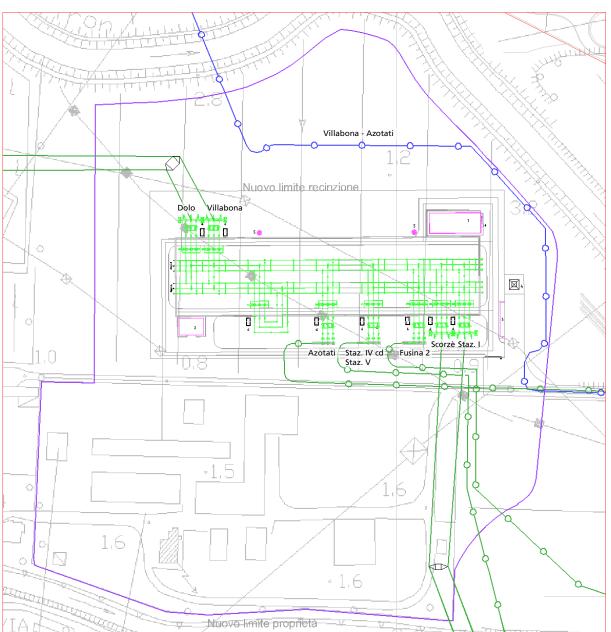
Planimetria della stazione "Malcontenta". In verde i collegamenti a 220 kV e in blu il collegamento a 132 kV.
